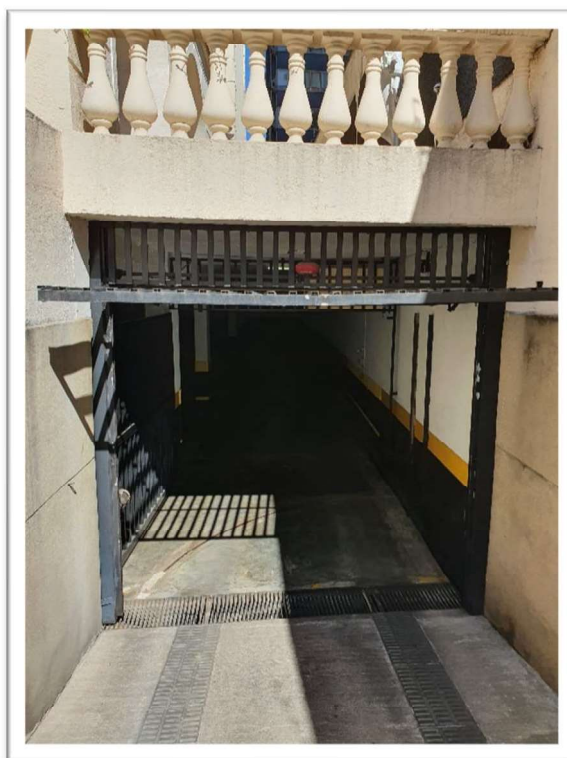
PORTÃO DE ENTRADA DA GARAGEM
